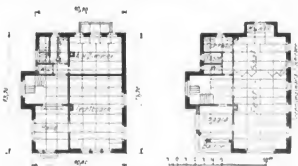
Grundriss vom Erdgeschoss und ersten Obergeschoss. 1 : 400.
